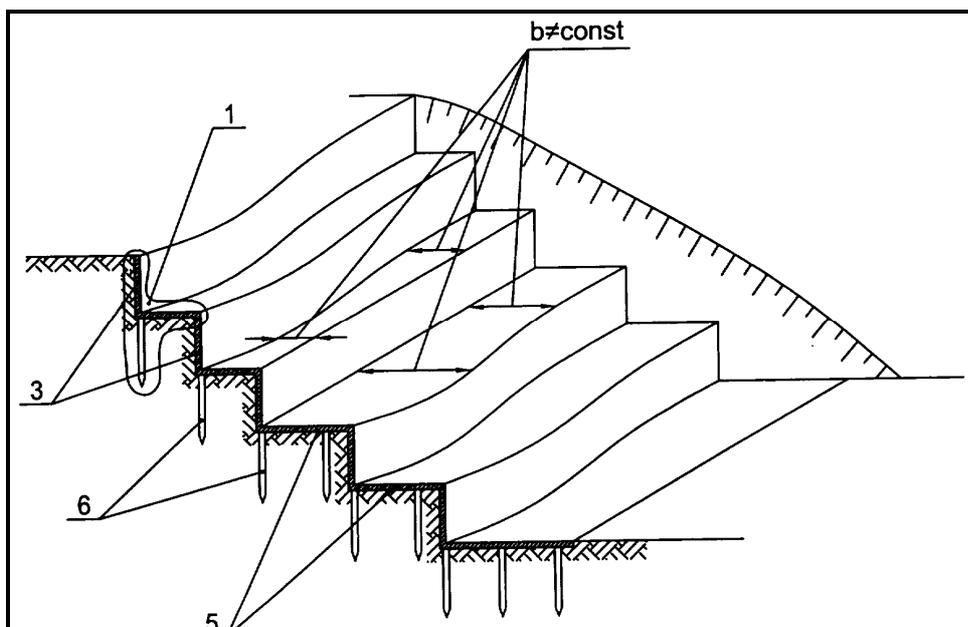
Фундамент здания, вид фундаментных горизонтальных железобетонных плит, имеющих переменную ширину
